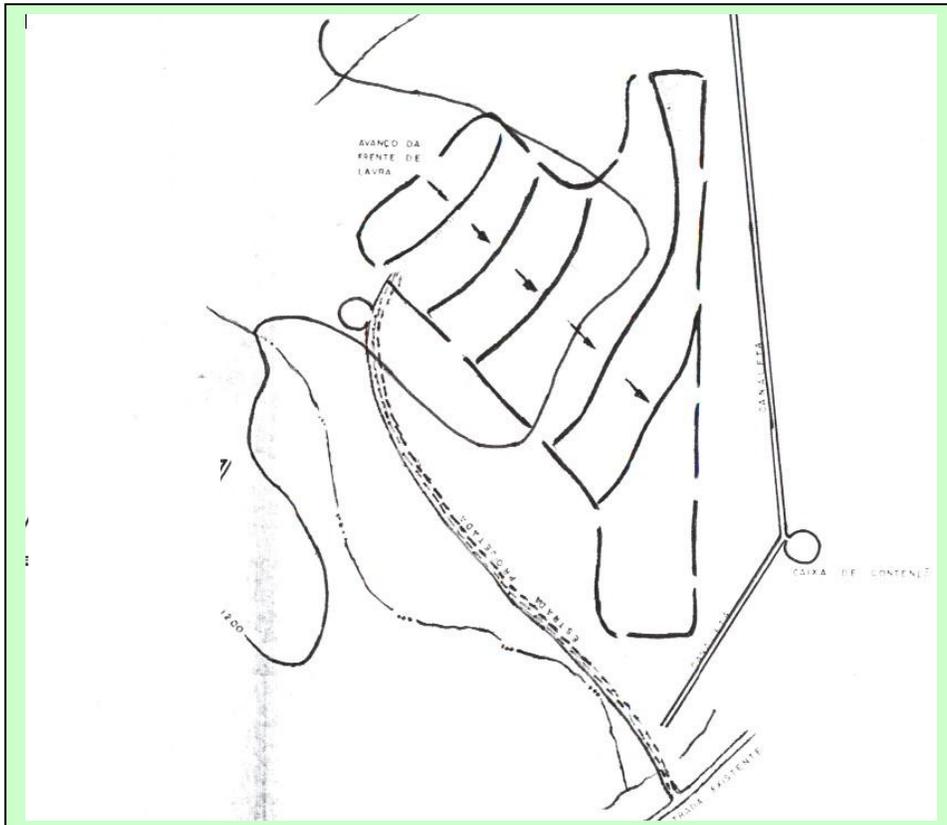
Infra-estrutura projetada para a área 287 – Área de Intervenção
